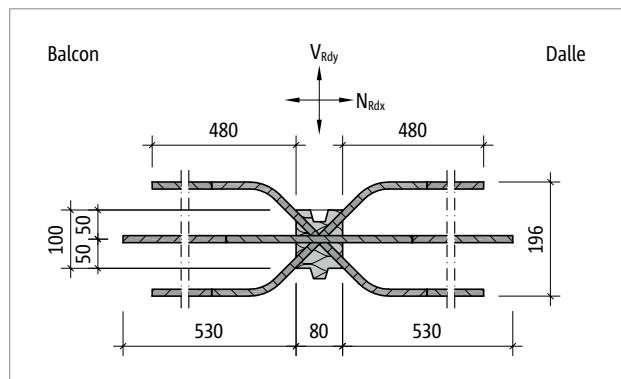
Schöck Isokorb® T Type H-VV2-NN1 : Plan de base du produit
